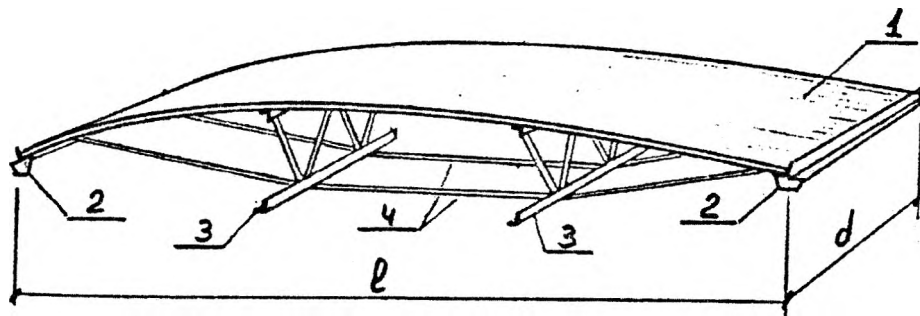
Общий вид панели-оболочки: 1 – пролётная конструкция; 2 – опорные элементы; 3 – решётчатые стойки; 4 – затяжки
